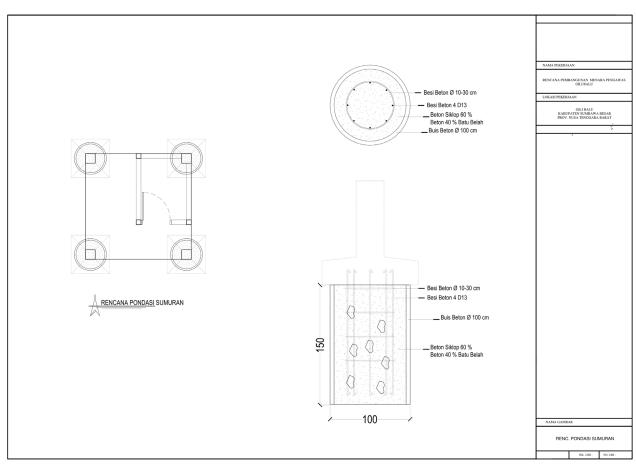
## DETAIL ENGINEERING DESIGN RENCANA PEMBANGUNAN MENARA PENGAWAS/PANDANG GILIBALU
